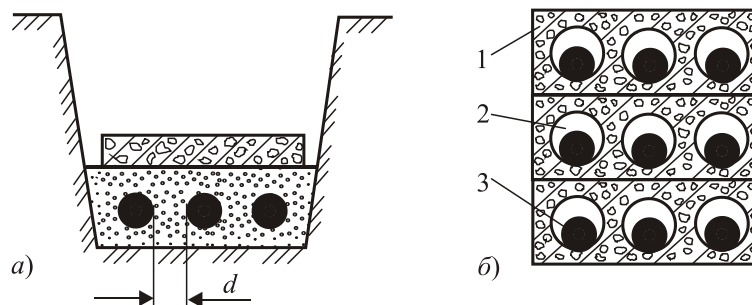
Прокладка кабелей в земляной траншее (а) и бетонном блоке (б)
